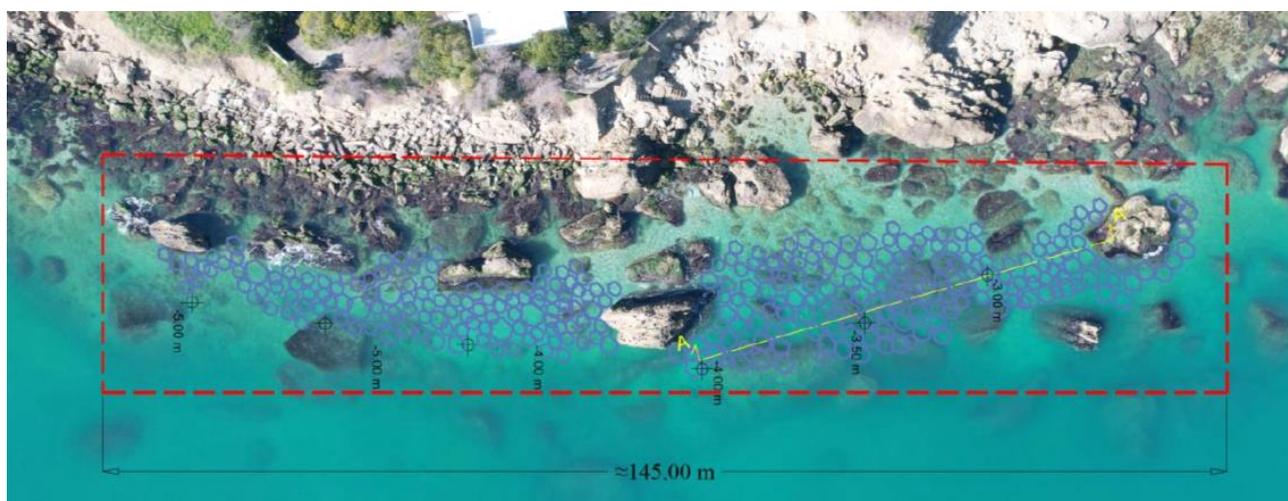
Planimetria tipo di progetto (fonte Relazione generale del progetto)
